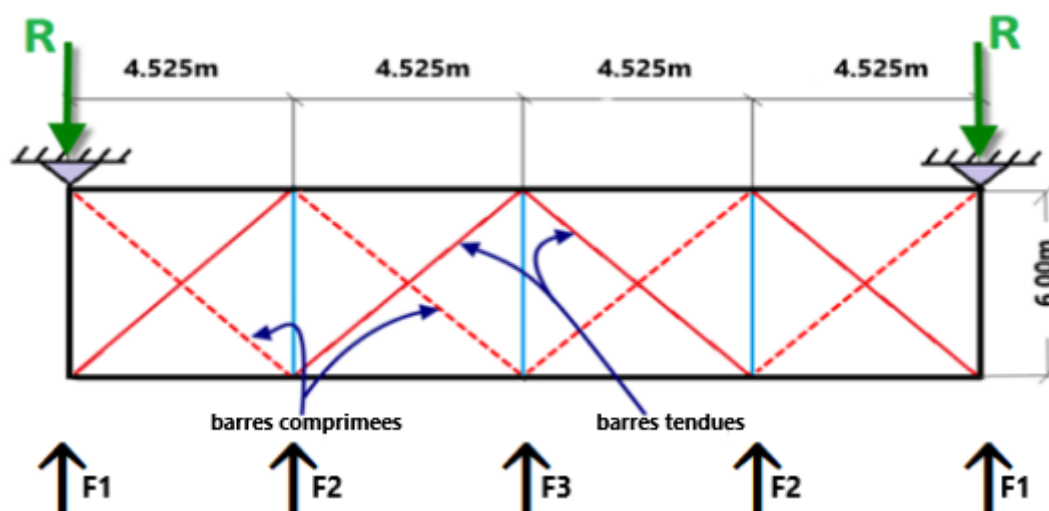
Schéma statique de la poutre au vent (effet de traction).
